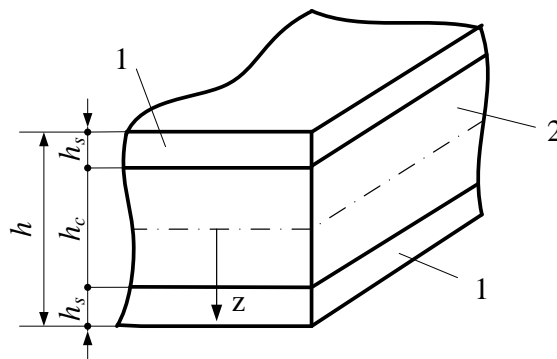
Поперечное сечение плиты: 1 – стальной лист, 2 – бетон
